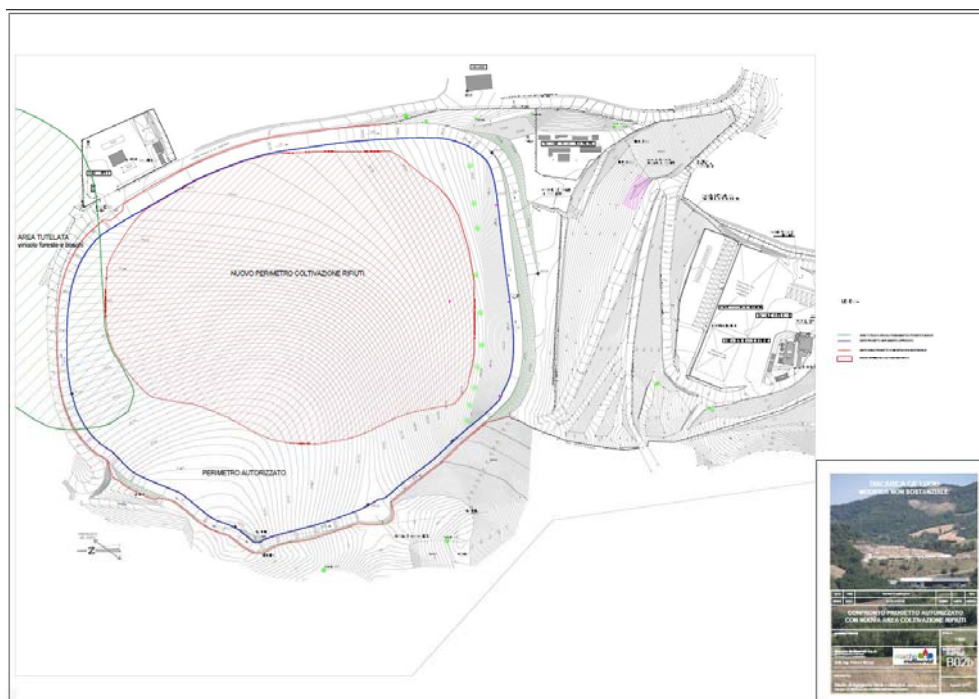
planimetria di confronto tra progetto autorizzato ed il presente progetto
